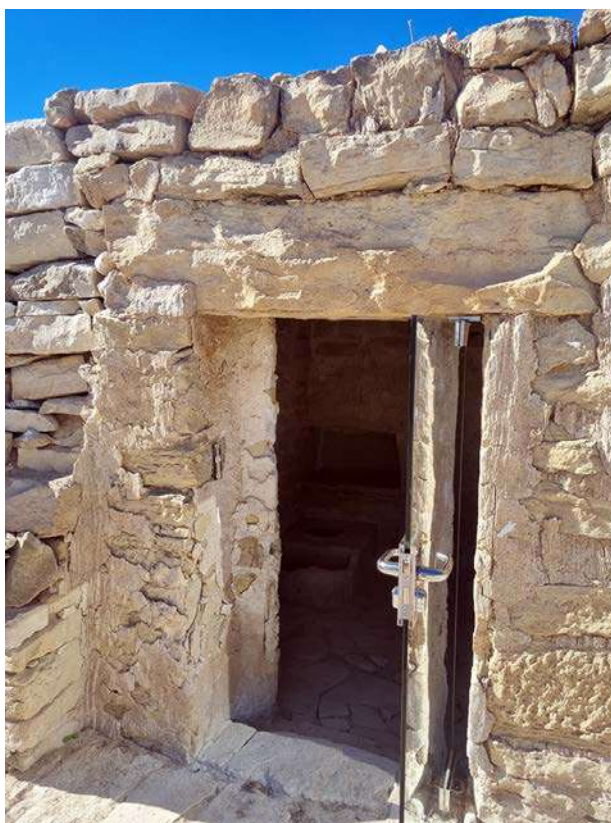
Detalle acceso al refugio con la puerta de vidrio abierta
